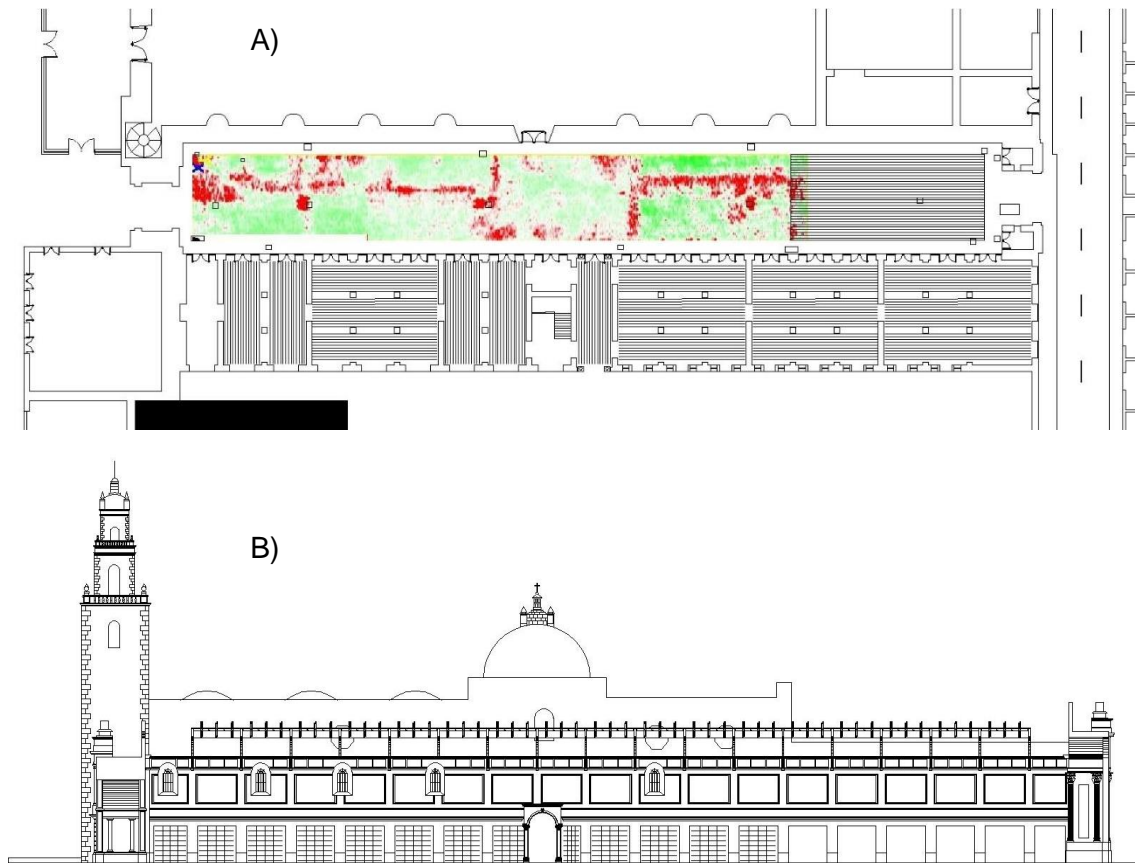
Propuesta de zonas para realizar prospección geofísica con georradar; A) Planta del Pasaje de la Revolución; B) Corte del pasaje con vista norte, donde se aprecia la retícula de prospección en el muro sur de la Catedral de Mérida.
